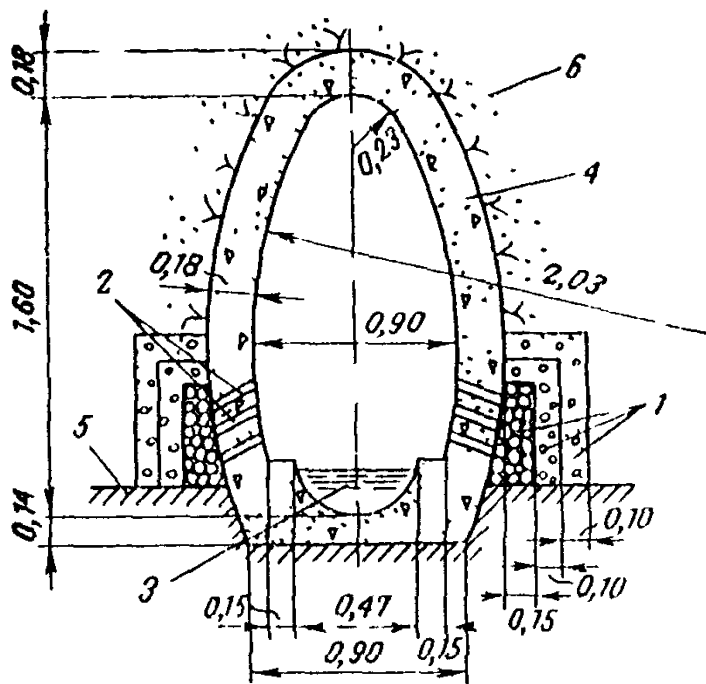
Конструкция дренажного туннеля с наружным фильтром, [Л 30]
